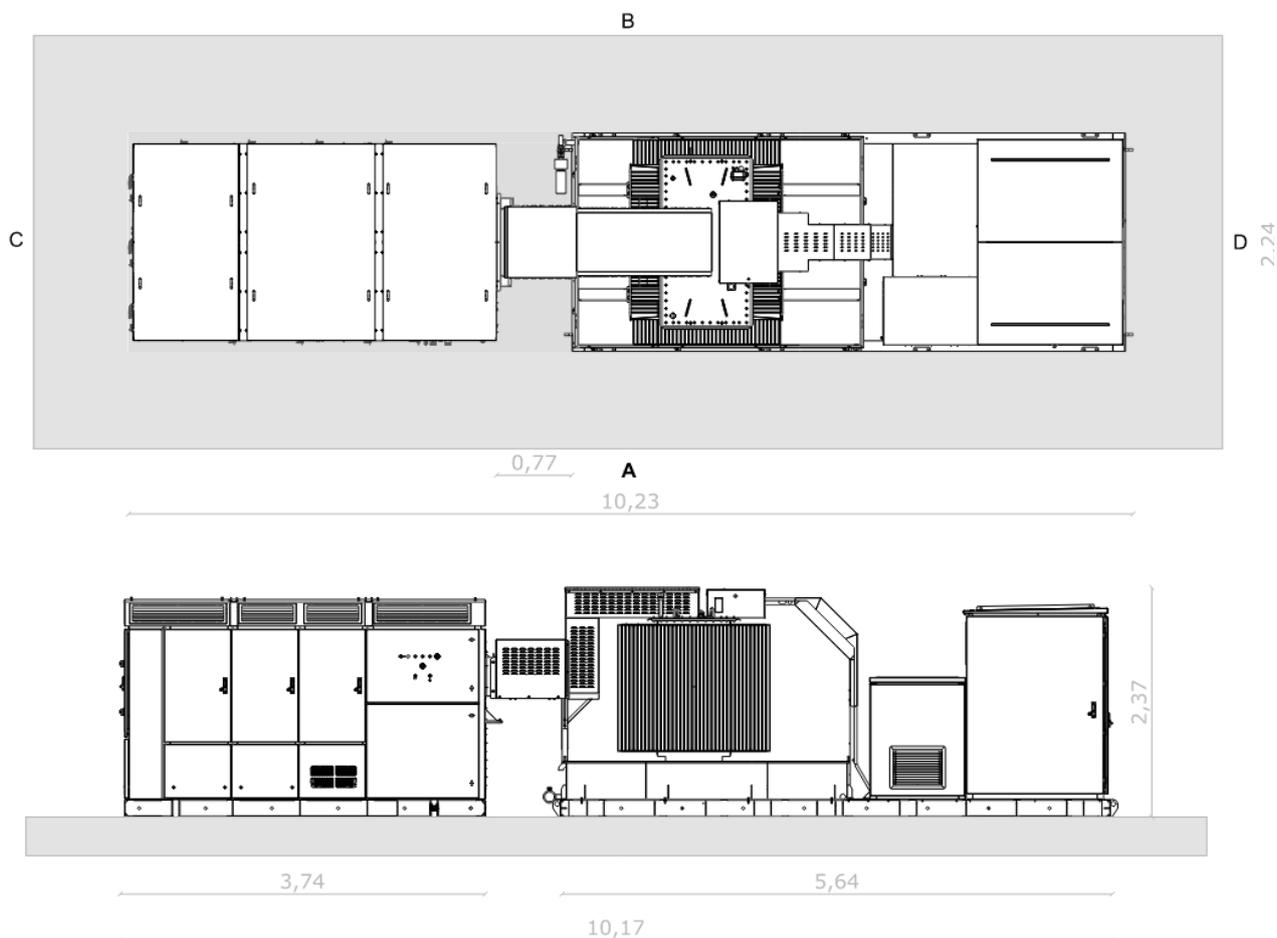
Cabina di conversione e trasformazione – Pianta e prospetto
